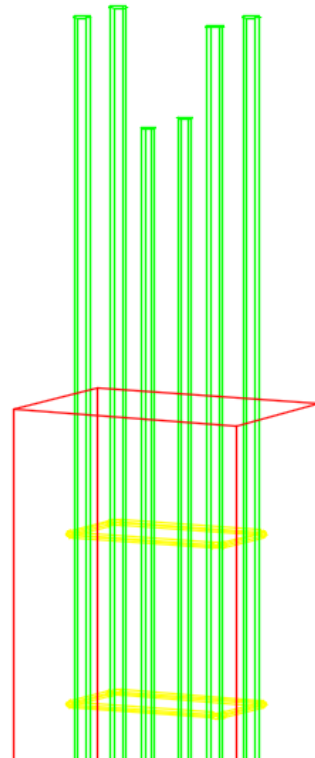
Pormenor 1 - barra (Fund. – Piso 1).
